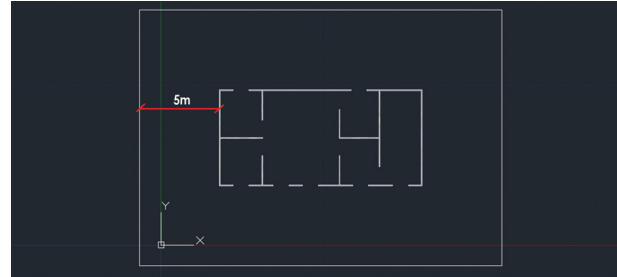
Configuración 1 de la planta arquitectónica del caso base.
